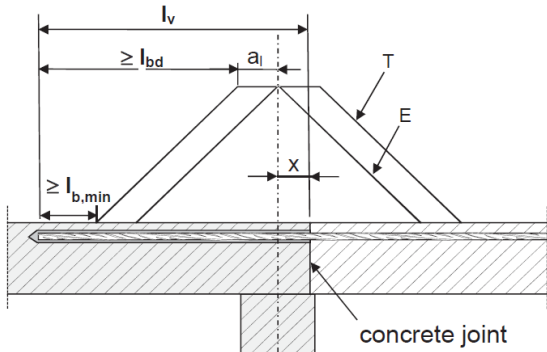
Anclaje final de placas o vigas, diseñado como simple apoyo
